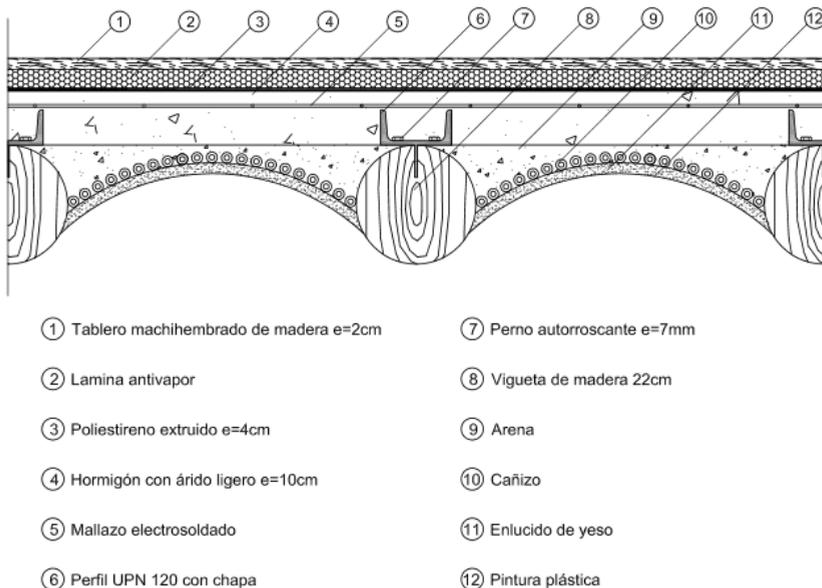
Propuesta forjado planta segunda. 2014. Propia.
